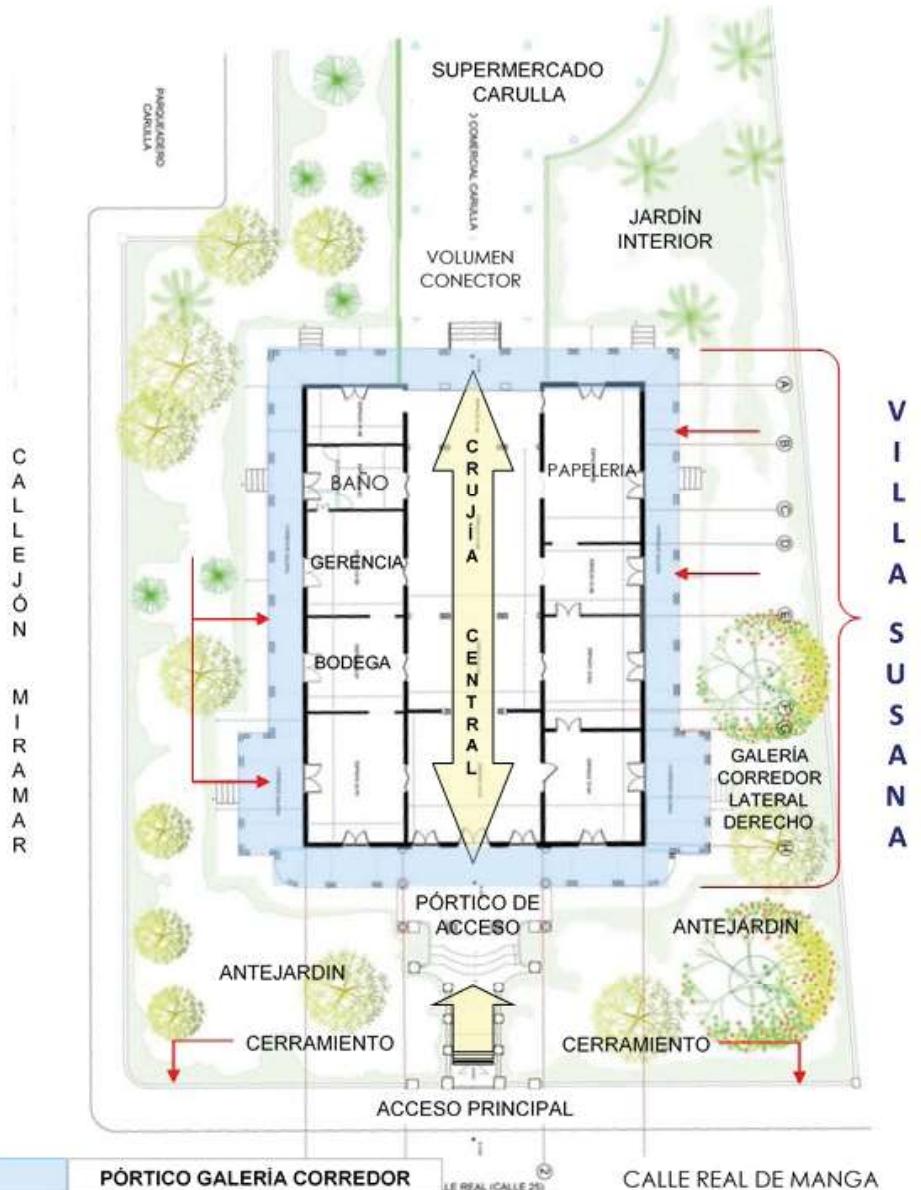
Planta arquitectónica general dibujada en AutoCAD, en ella se registra su distribución espacial. Contiene ambientación. Fuente: Archivo del autor. 2015. Fachada principal – fachadas y cortes.
